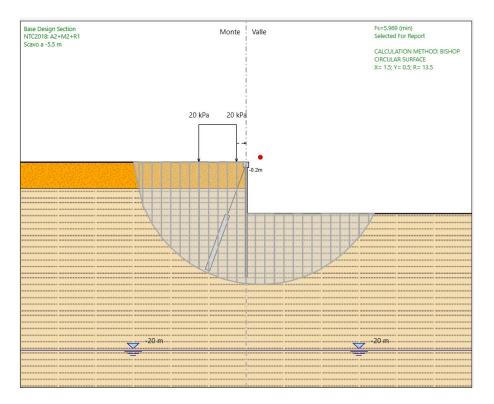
Sezione Tipo B1 - Condizioni statiche (FS=6.0)
